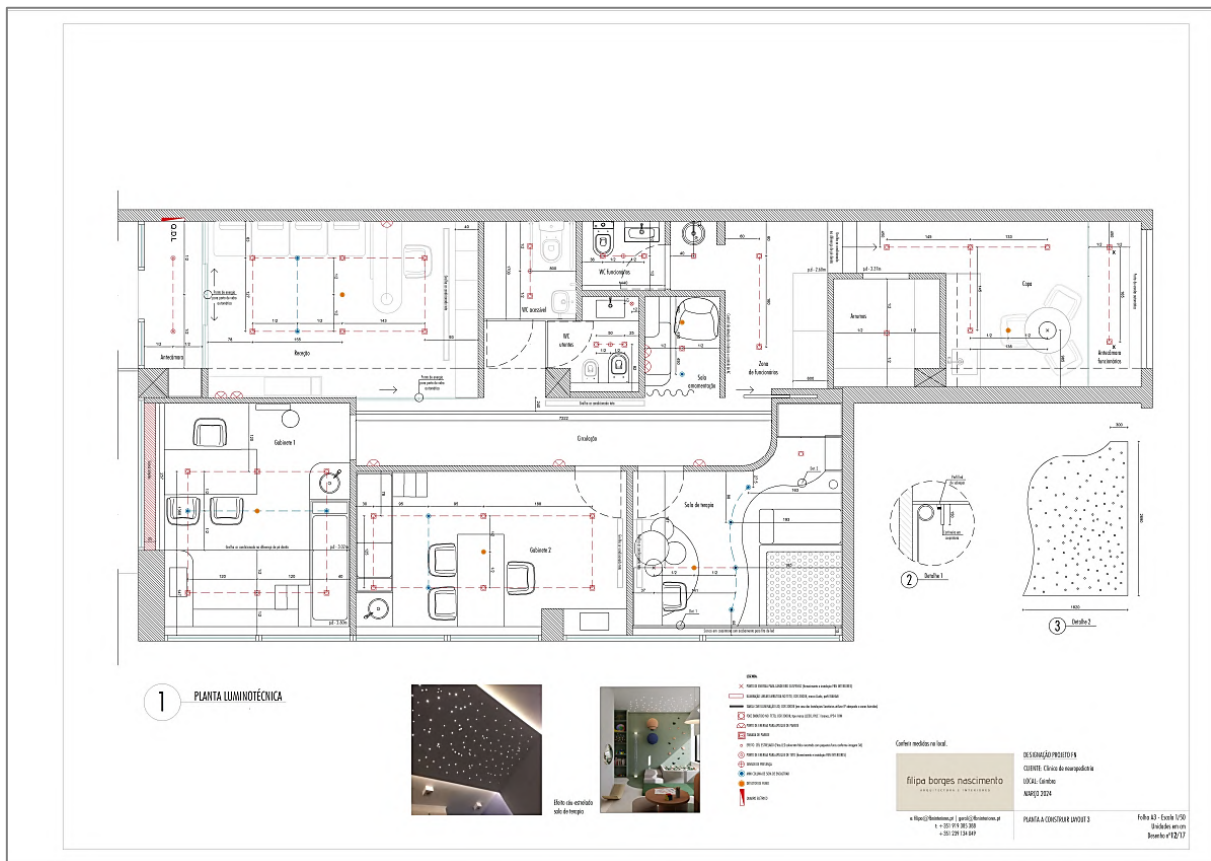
Planta luminotécnica do layout final - Projeto CNP. Fonte: Equipa FBN.
